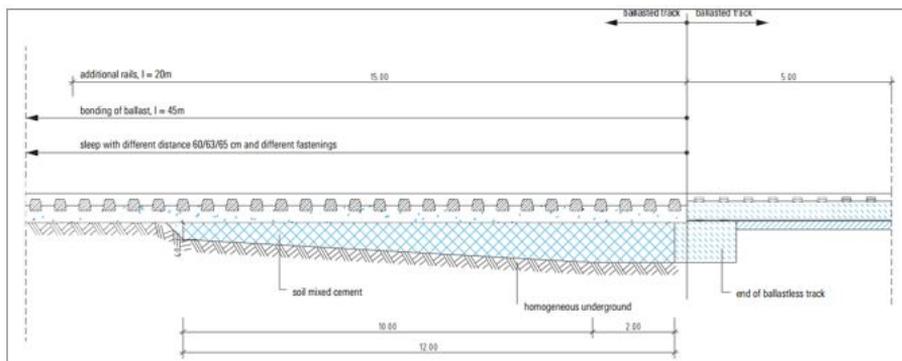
Esquema de transición placa-balasto planteado por la empresa SSF Ingenieure, (FUENTE: Slab track systems on different substructures. SSF Ingenieure [7])
